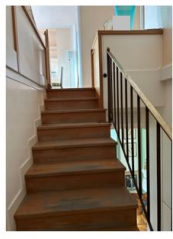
Secondo piano - Scala interna di accesso al piano piano
